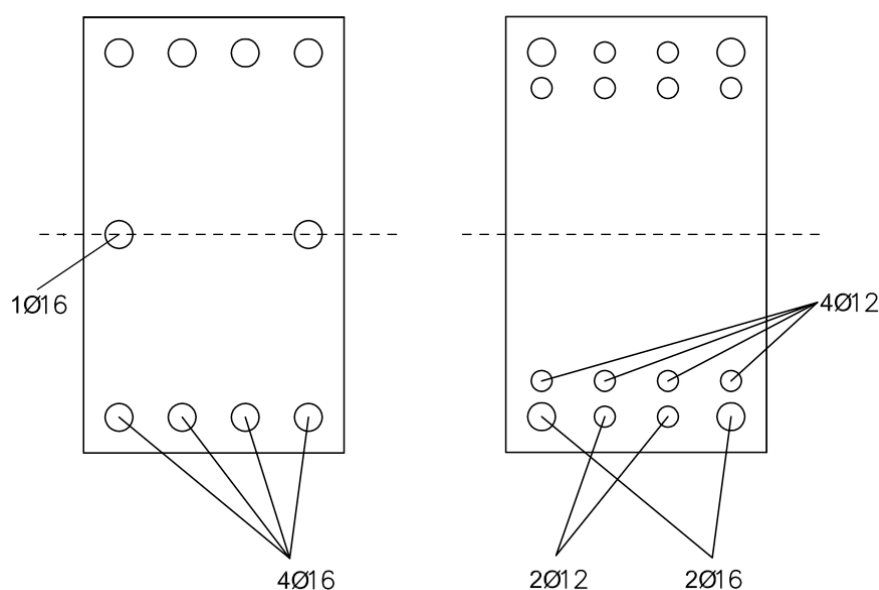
Exemplo de armaduras para Pilares em flexão composta.
